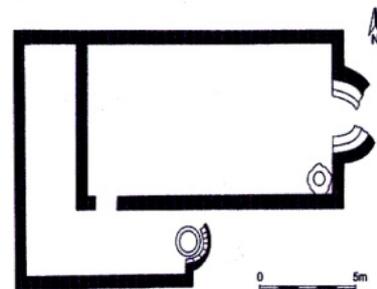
Kirche in Babotinac, Grundriss
